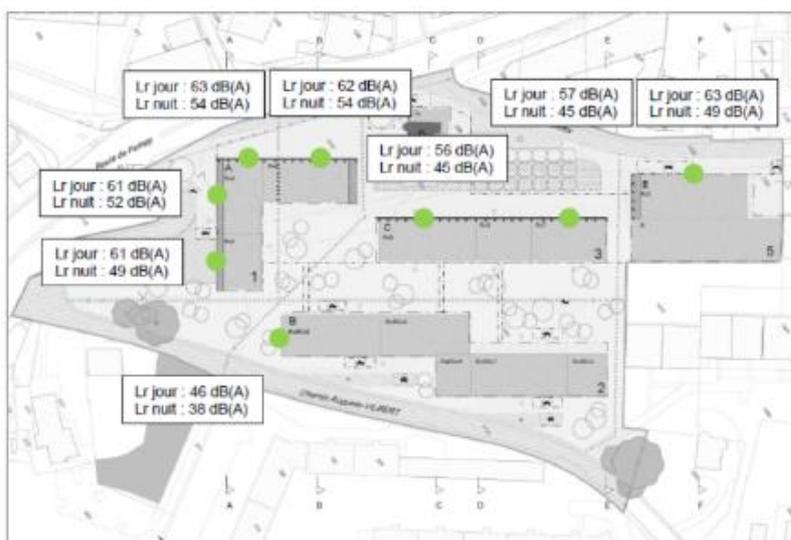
Niveau d'évaluation en façade du bruit routier et du bruit du tram (RDC)
